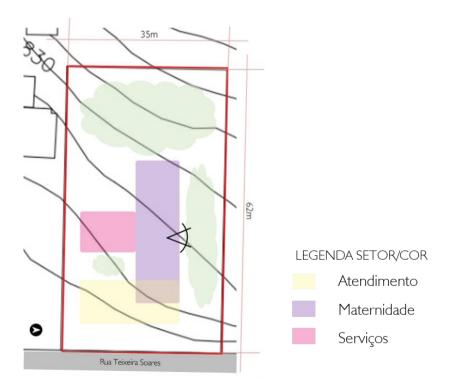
Estudo de implantação 1 - planta baixa esquemática
